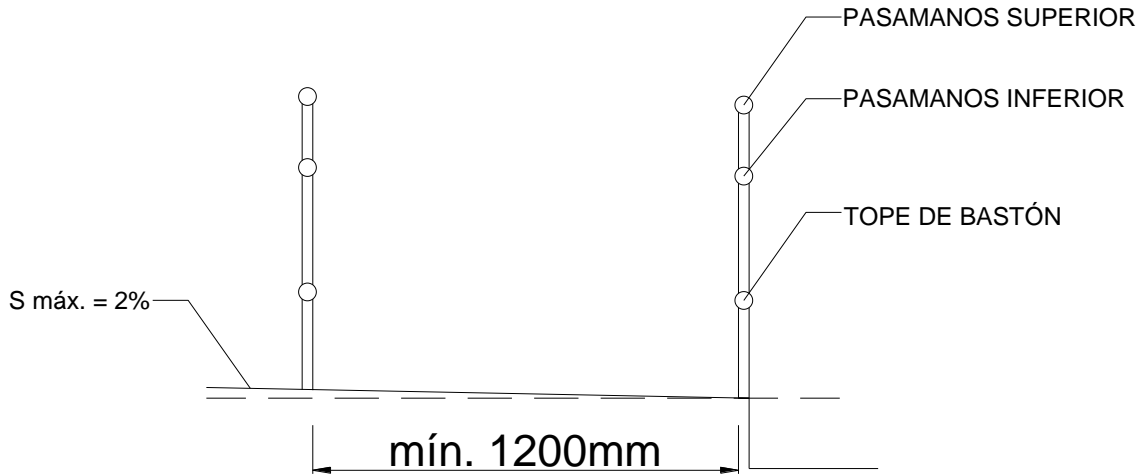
Detalle pendiente transversal y ancho mínimo, Fuente: NTE INEN 2245, P3
